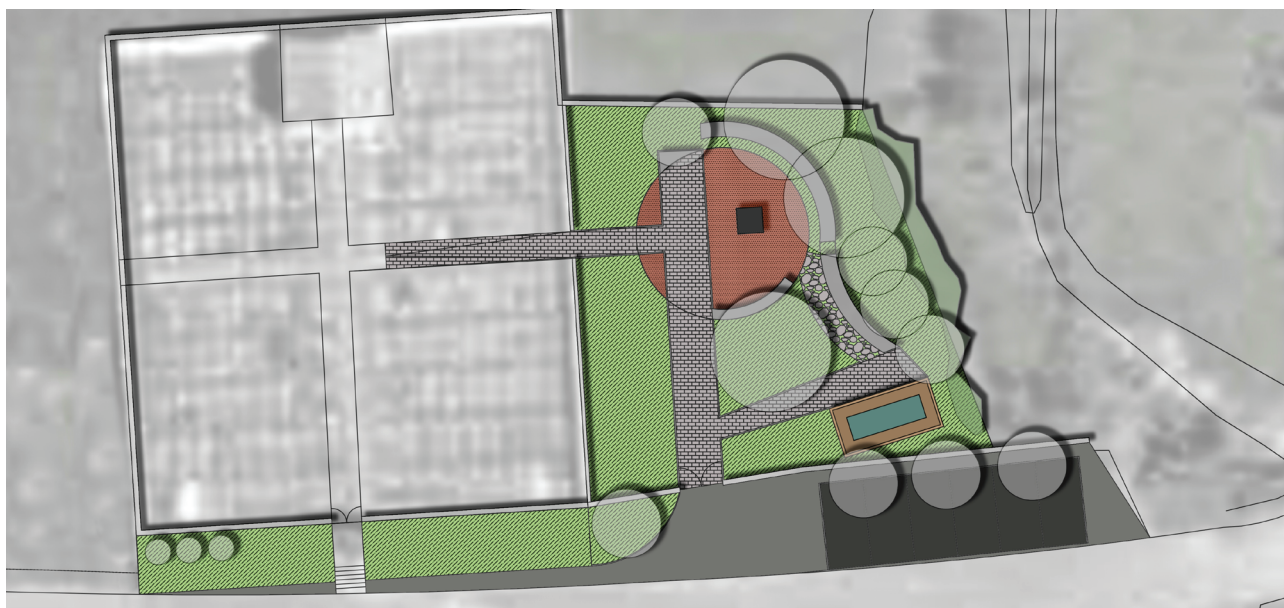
Planta Geral do projeto de requalificação do cemitério de São Brás
